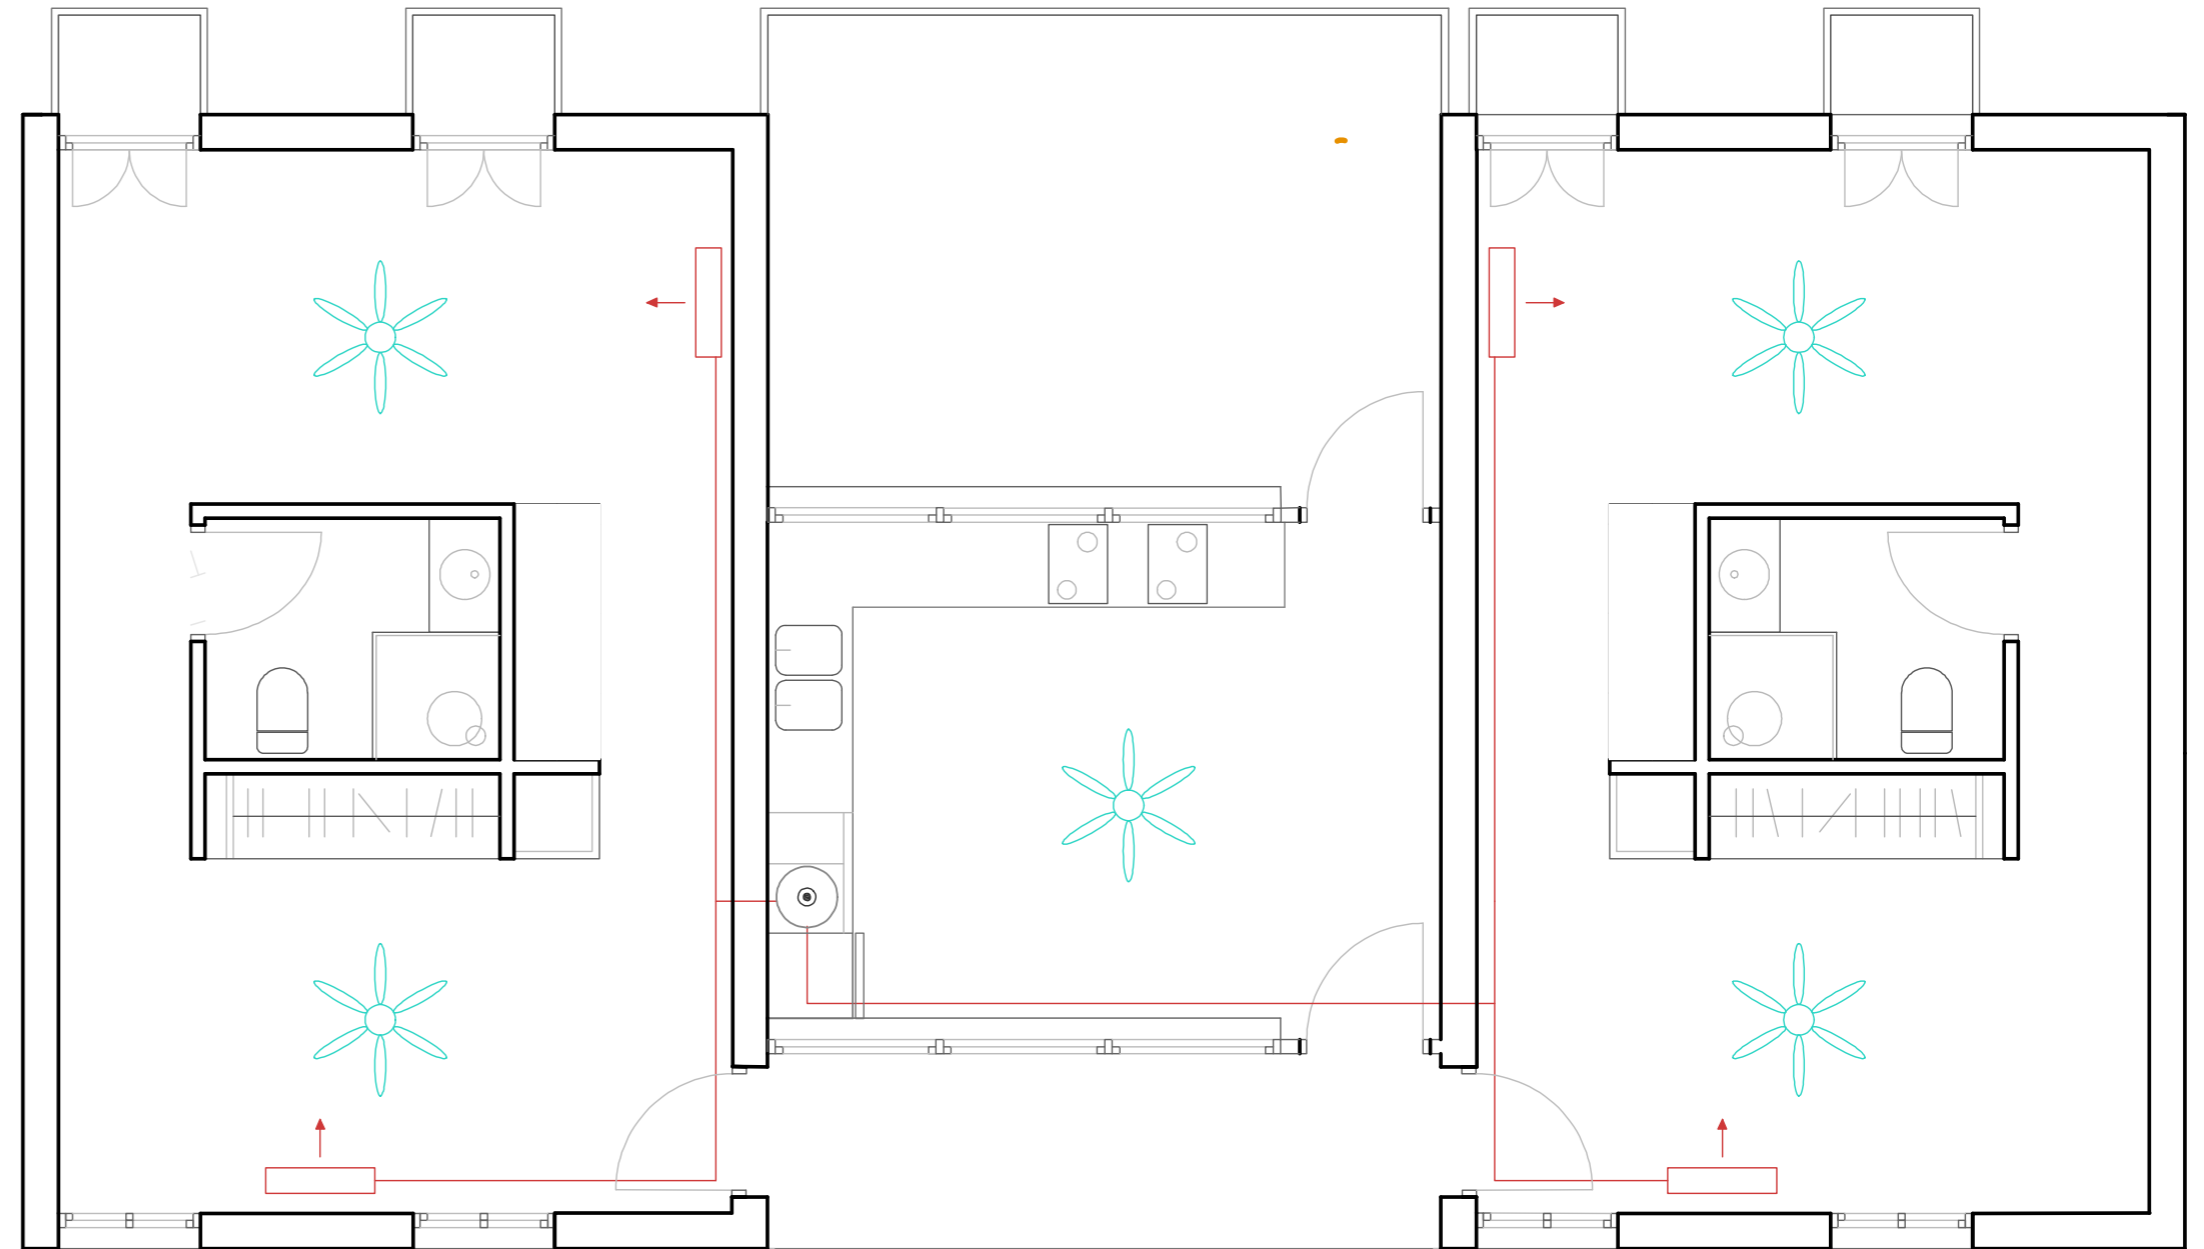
Planta de vivienda tipo B. Elaboración propia.
